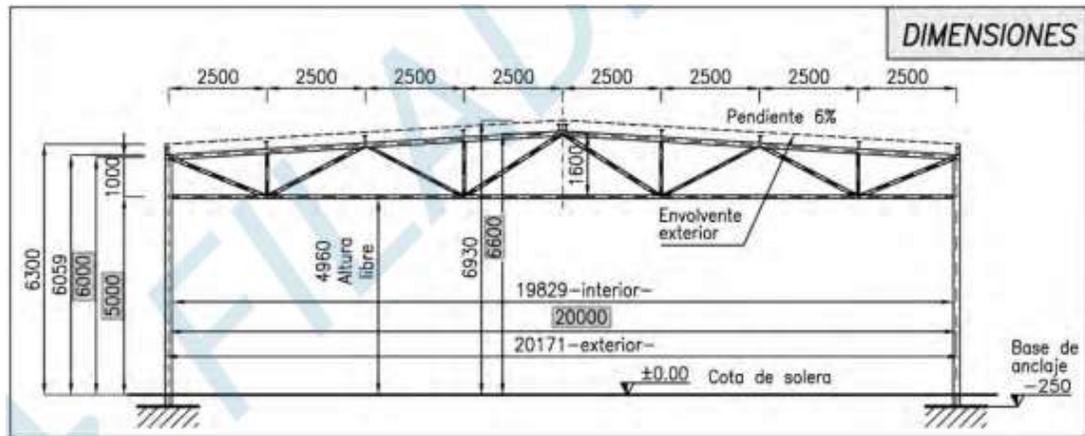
Tipología estructural y dimensiones que figuran en el plano de alzado (mm)
